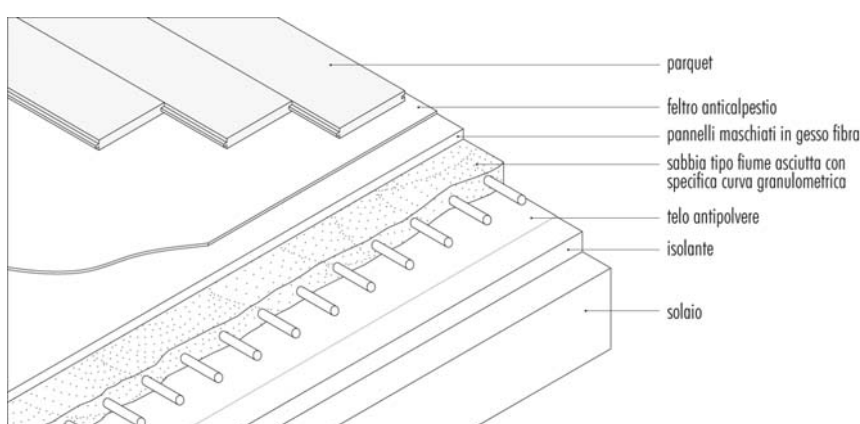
Pavimentazione in legno su massetto radiante a secco, in sabbia.
